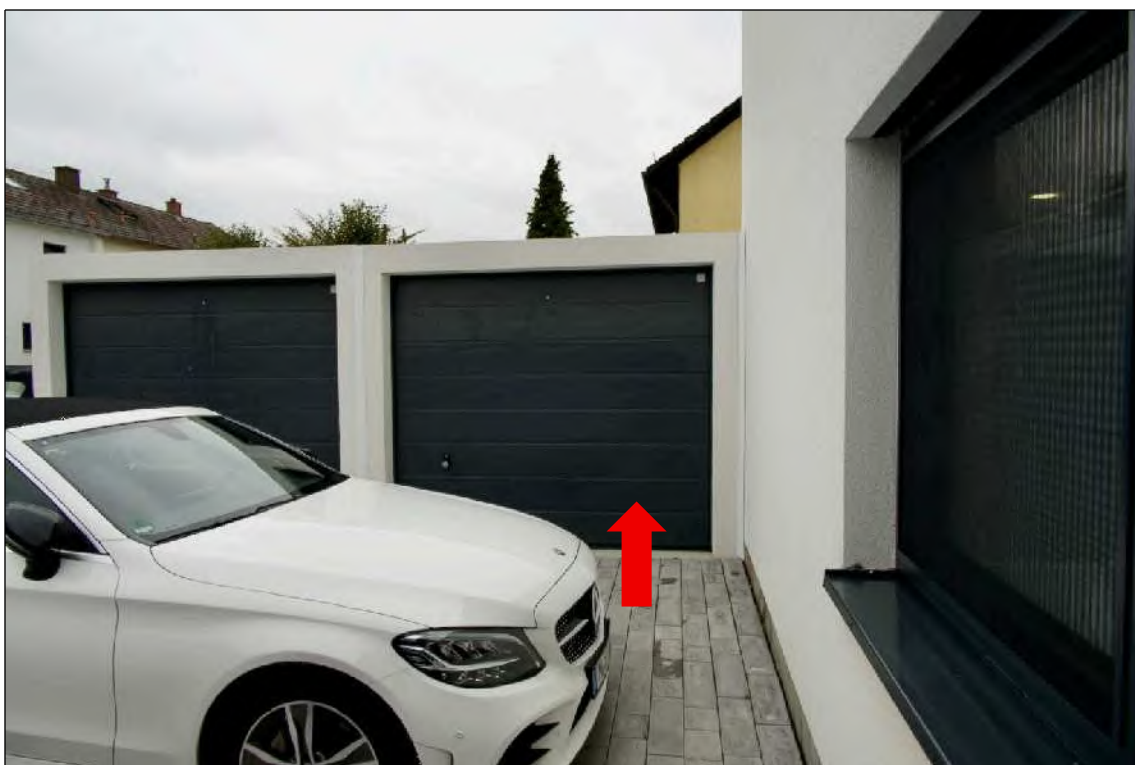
Einzelgarage (Grundstück Flurstück 2014/255)
